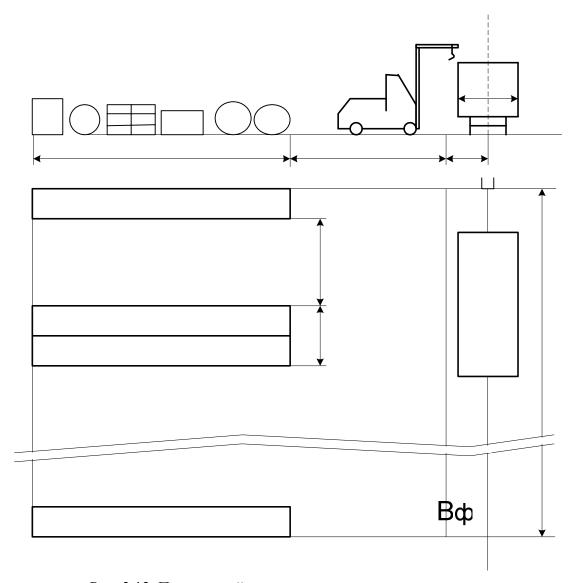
Поперечный разрез и план склада с автопогрузчиком
